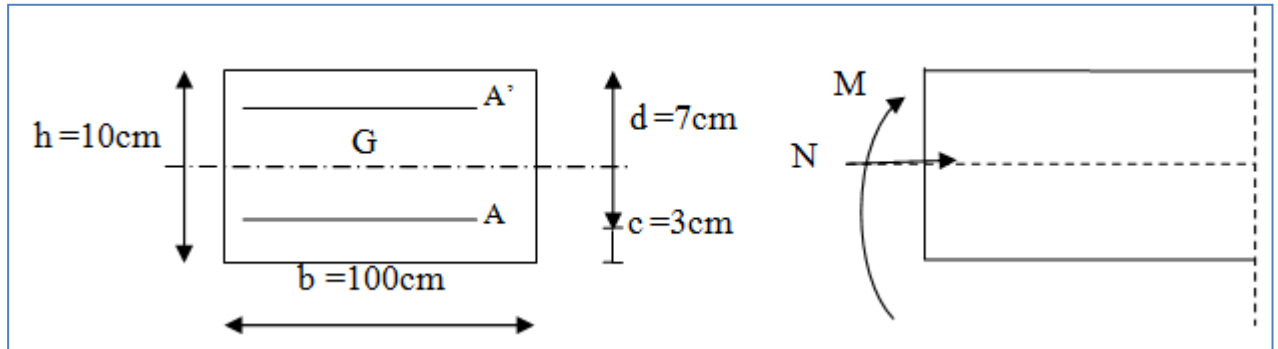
LA SECTION DE L'ACROTÈRE
